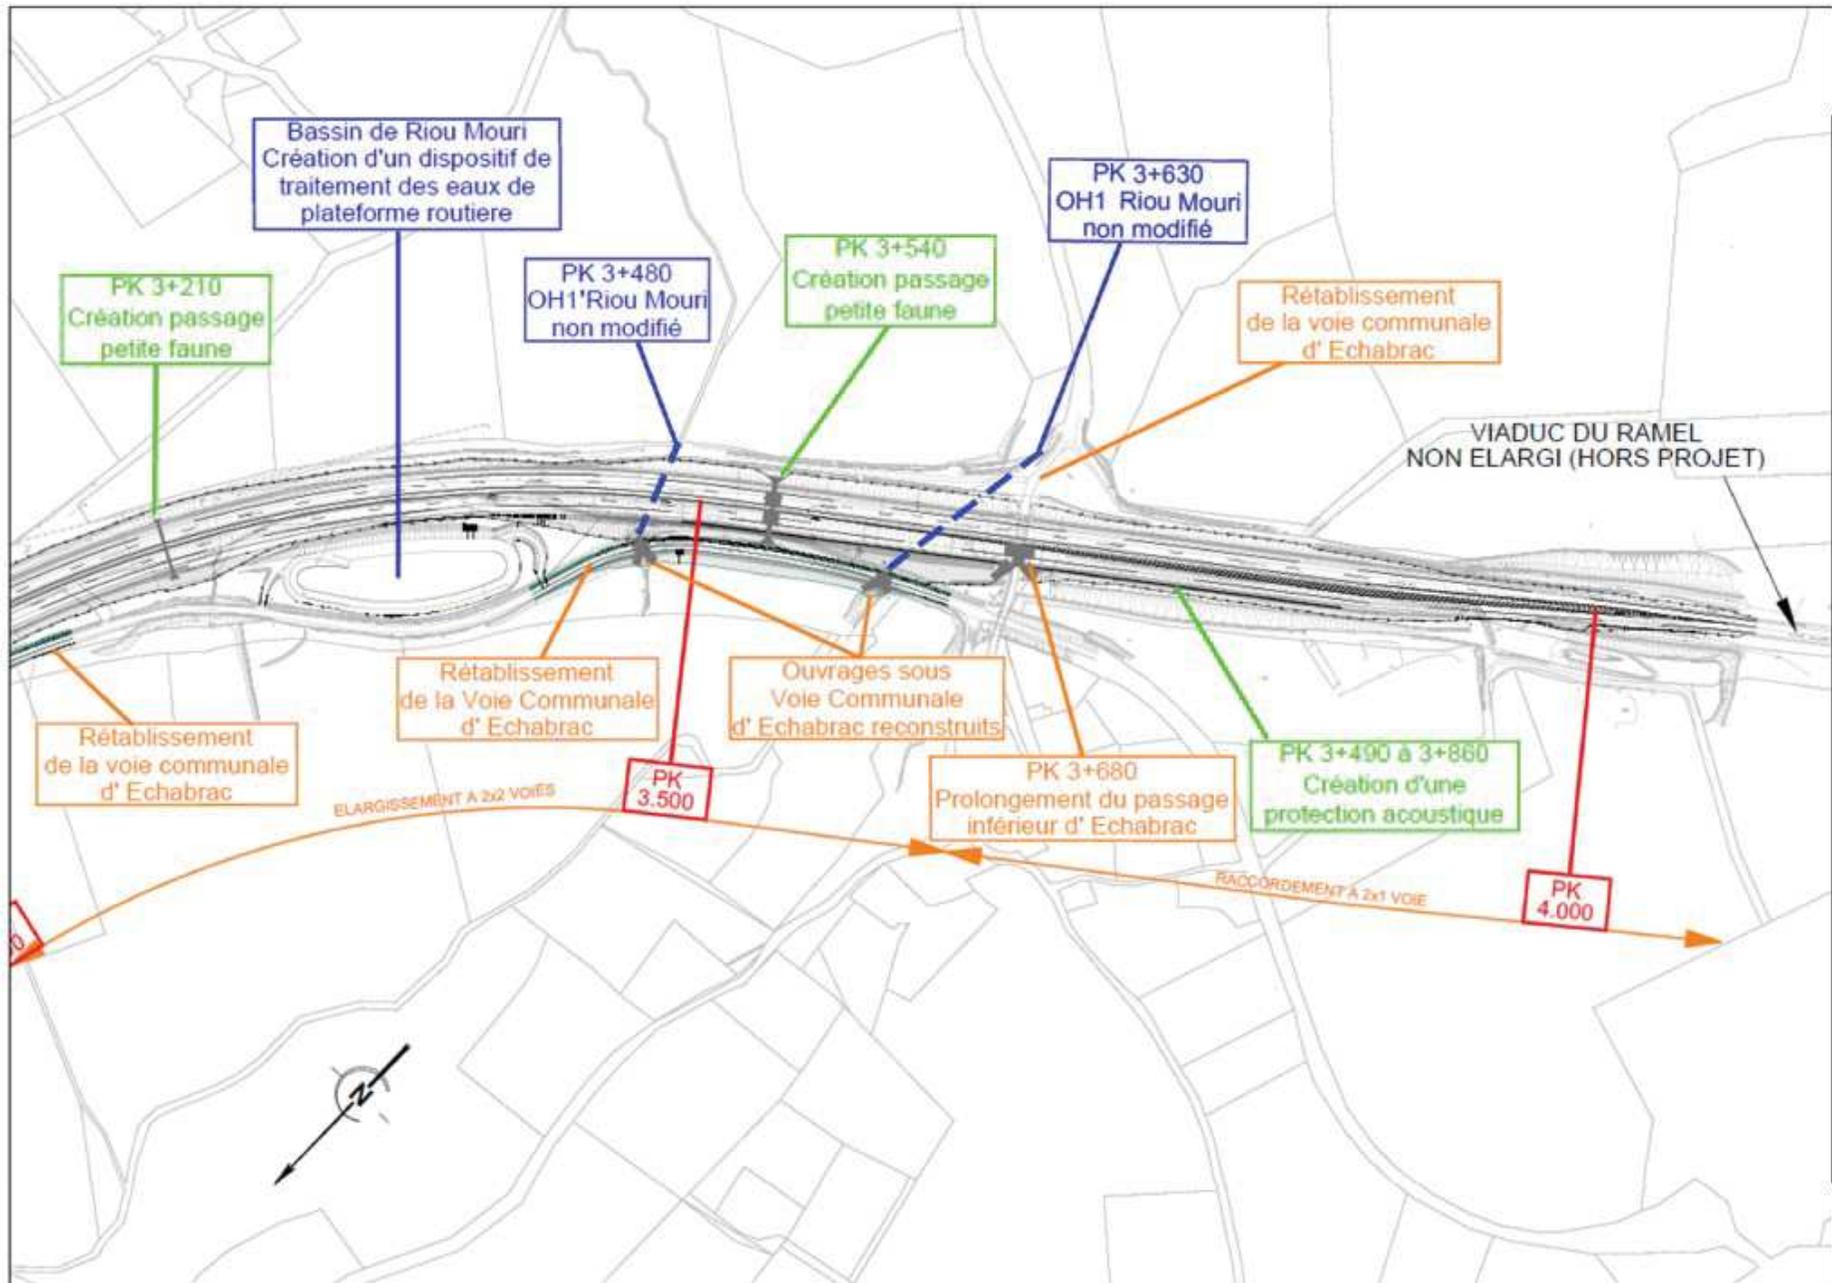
Plan général des travaux (source Artelia, mai 2019)
